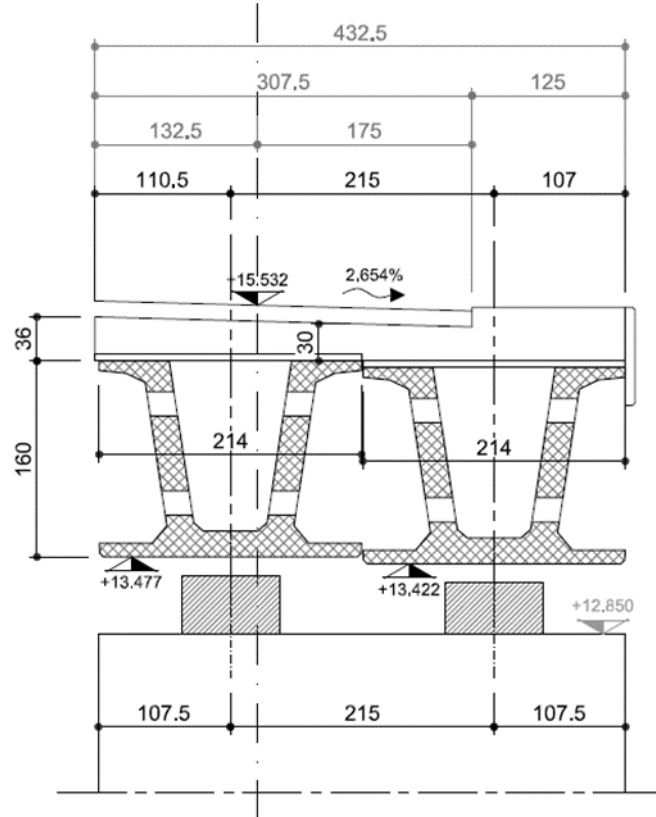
Sezione trasversale su P11S – Rampa S
